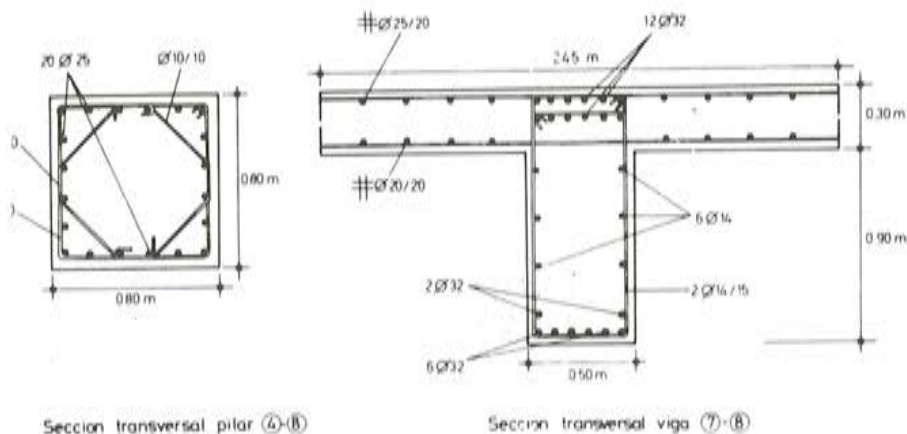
Secciones transversales genéricas del pórtico analizado
